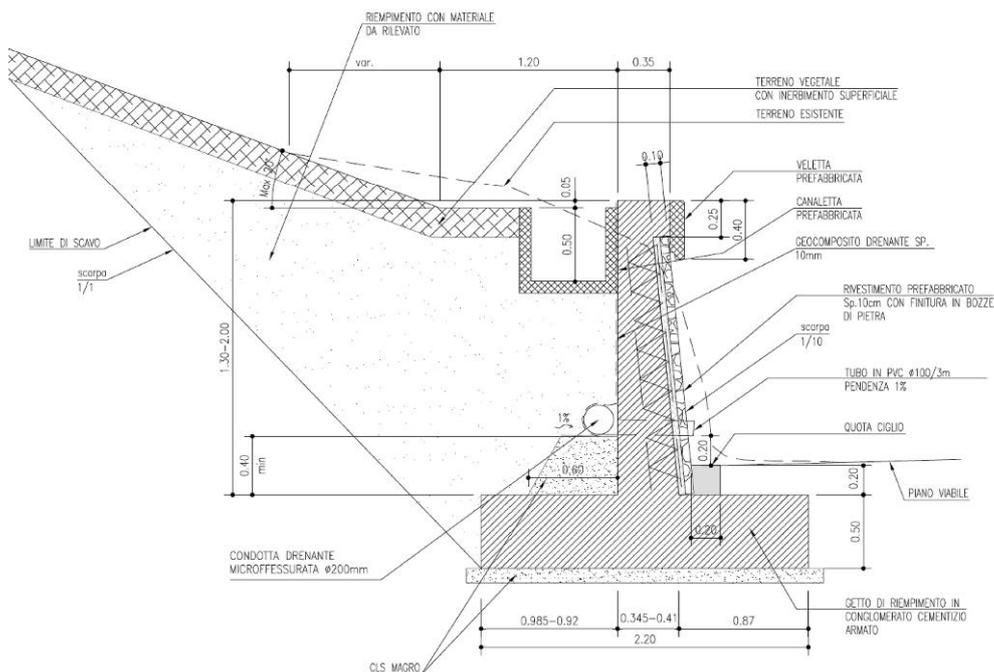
Sezione trasversale muro di controripa MC201 - H = 1.3/2.0 m
